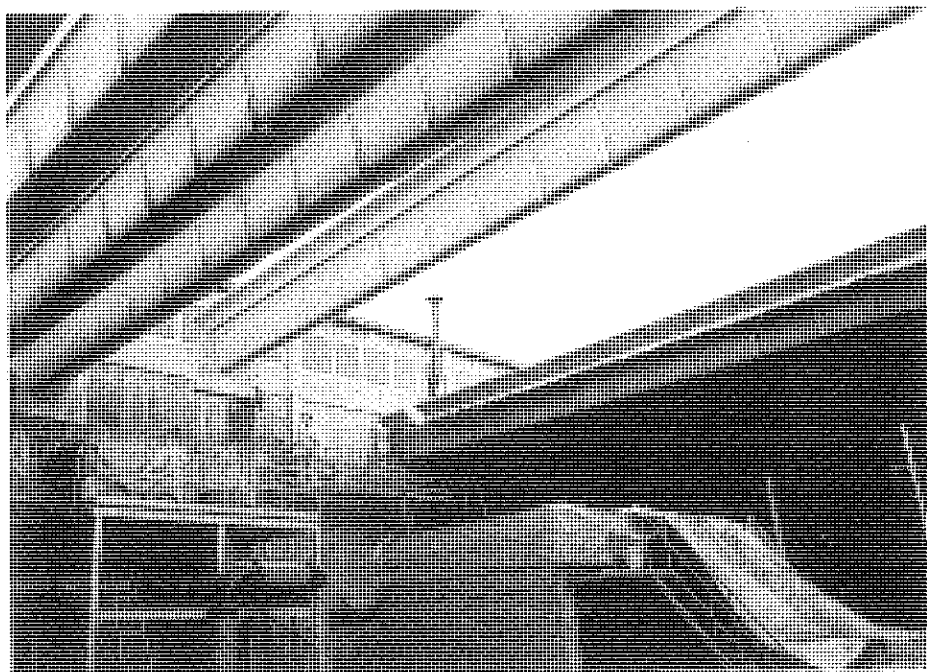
Colocación de una nueva viga. El montaje avanzaba simultáneamente con el desmantelamiento de la cubierta antigua.
